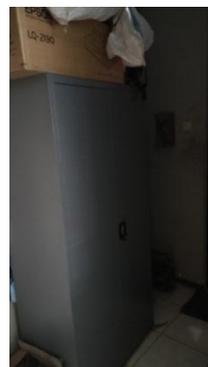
Foto Eksisting Partisi pada Lantai 1
